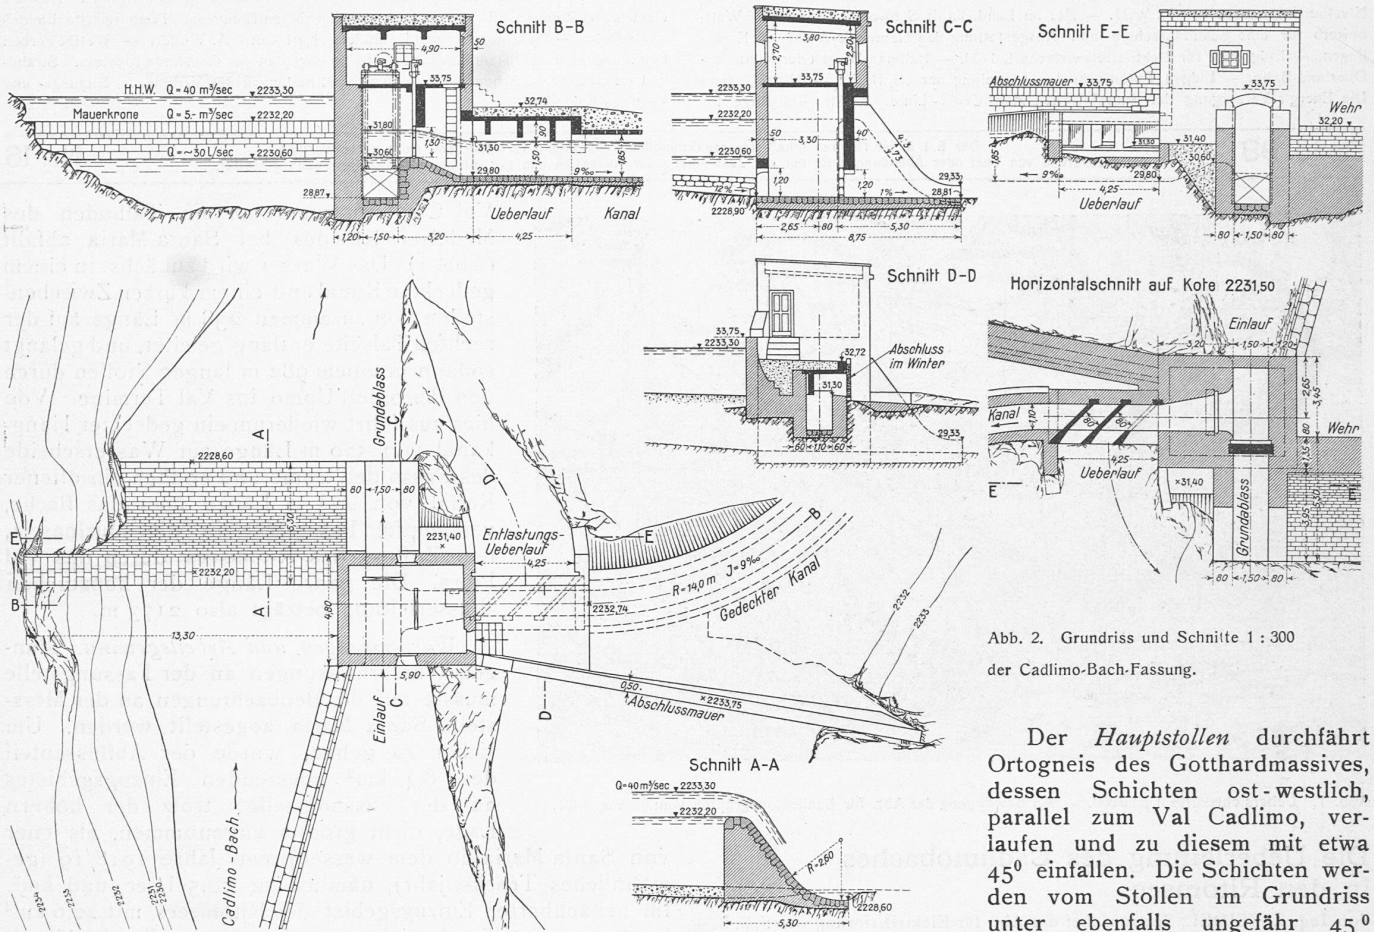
Grundriss und Schnitte 1 : 300 der Cadlimo-Bach-Fassung.
